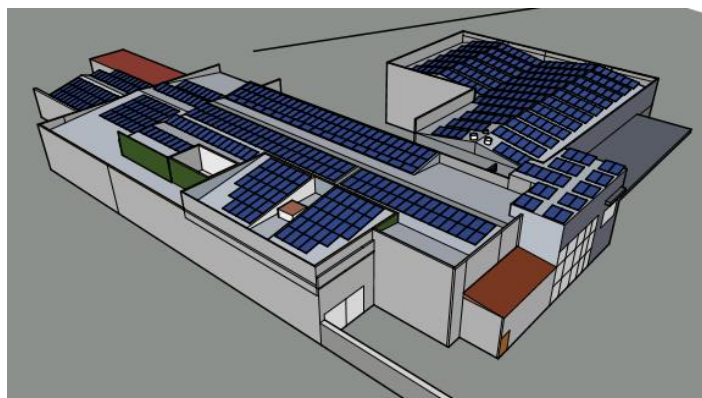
Implantação 3D da UPAC proposta para Benavente
